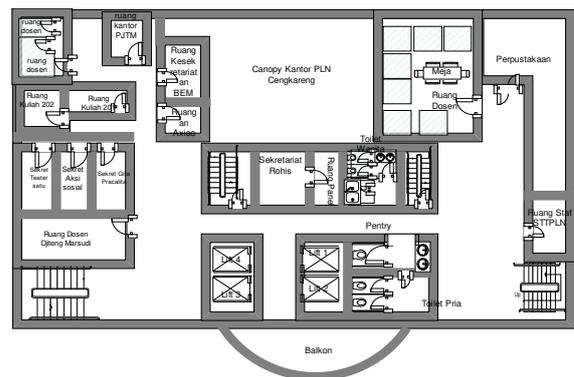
Denah Lantai 2 gedung utama kampus
